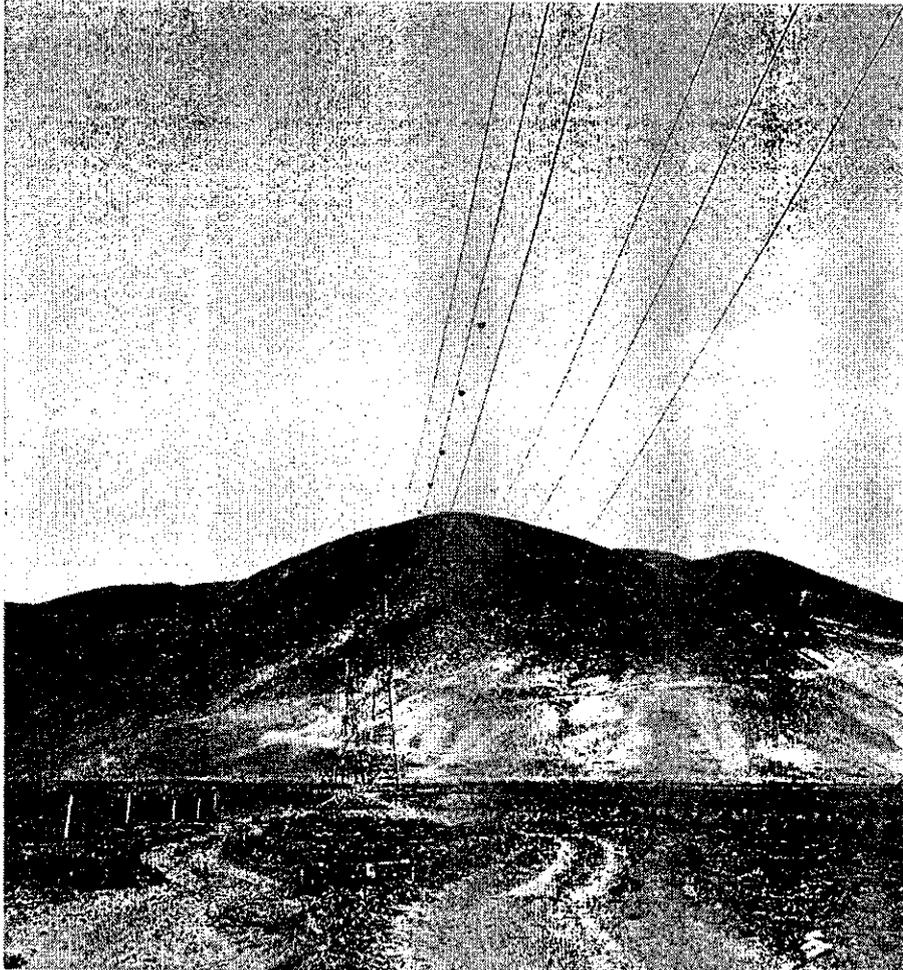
Salva pájaros en tramo Apoyo N°36- Apoyo N°37
